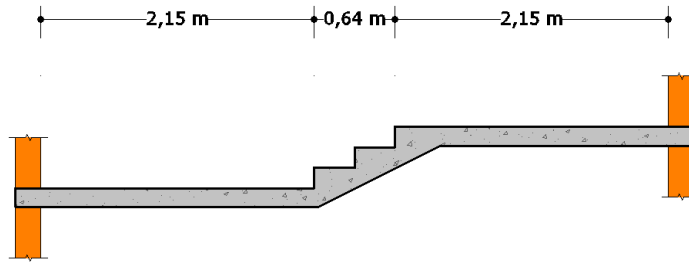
Segundo Tramo Escalera; Elaboracion Propia
